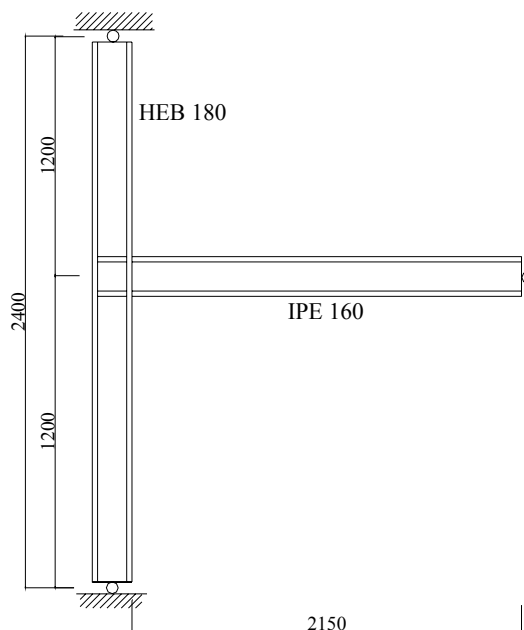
Geometria e dimensioni dello schema di prova dell'assemblaggio metallico.
